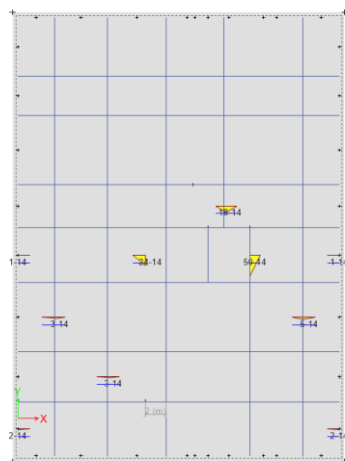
Ferrailage du radier sens y - face BOT RPA2024.
